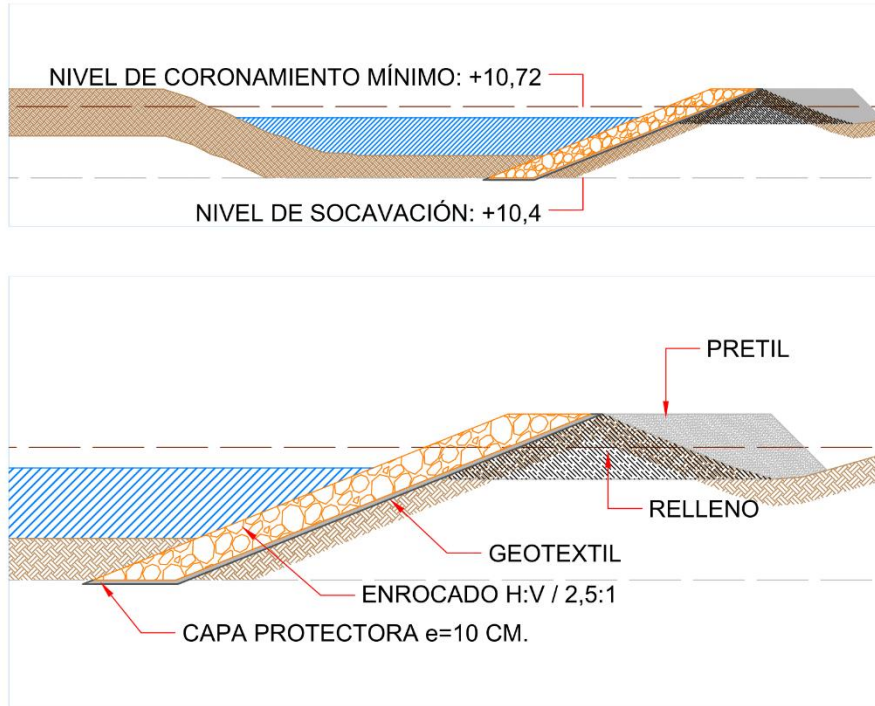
Corte transversal tipo para defensa de enrocados propuesta Acha Baja
